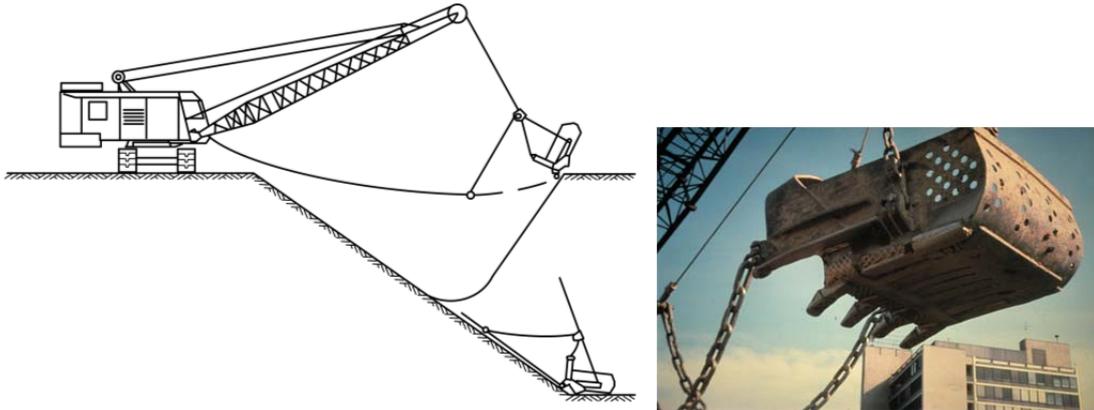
Seilbagger mit Schleppkübelausrüstung
